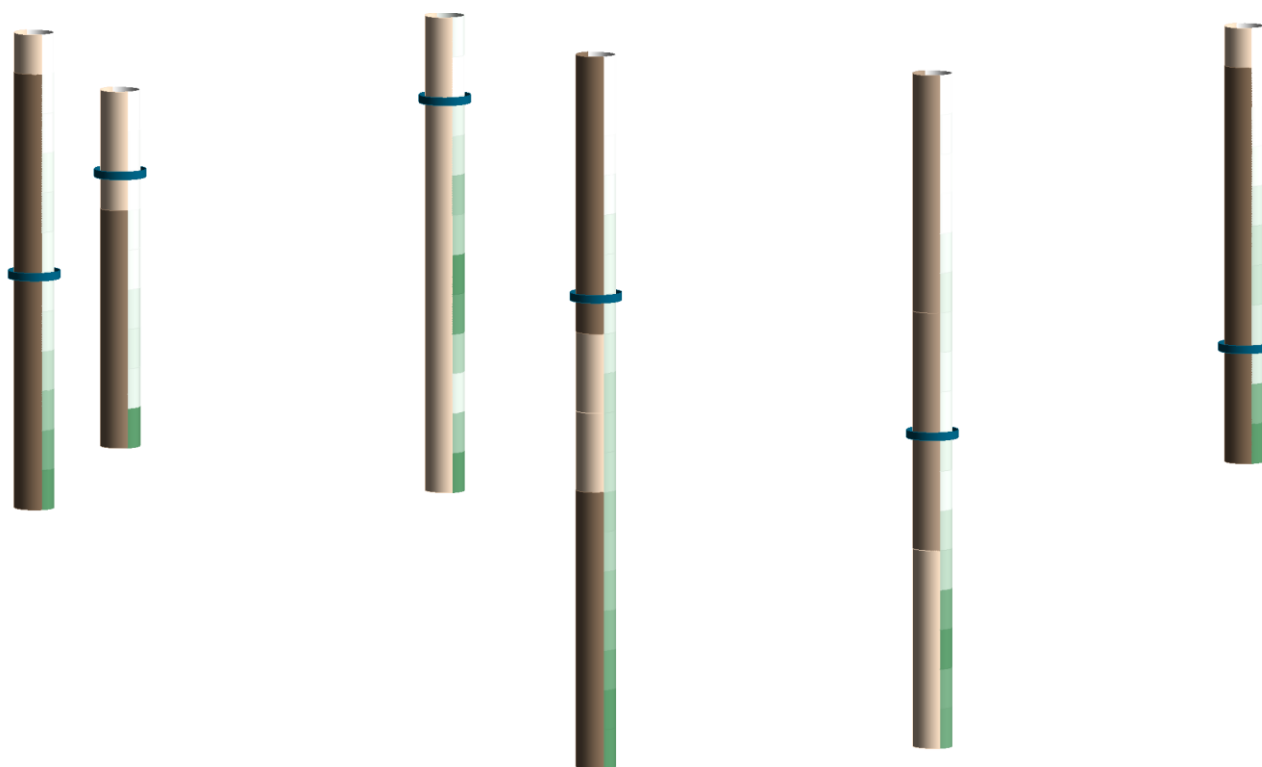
FS parametrizados conforme a planilha eletrônica de ensaio
